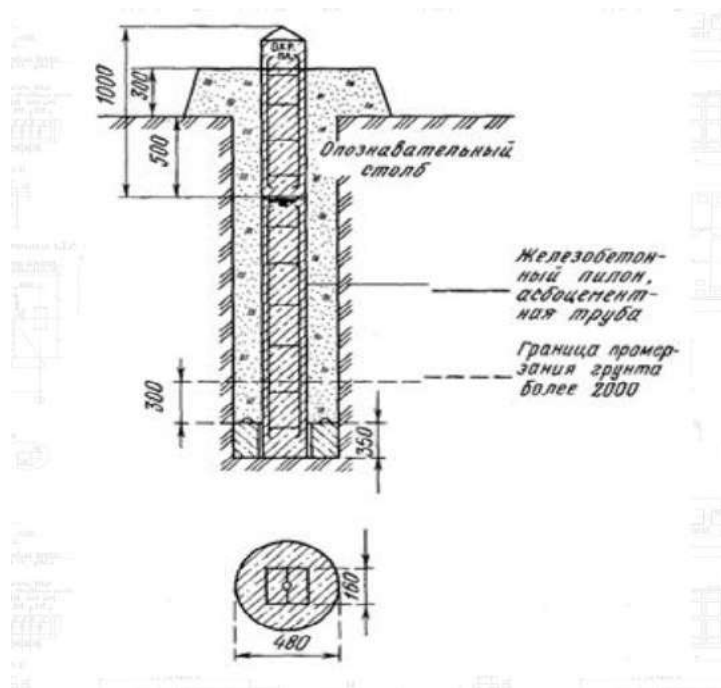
Конструкция грунтового репера опорной геодезической сети в условиях сезонного промерзания грунтов
